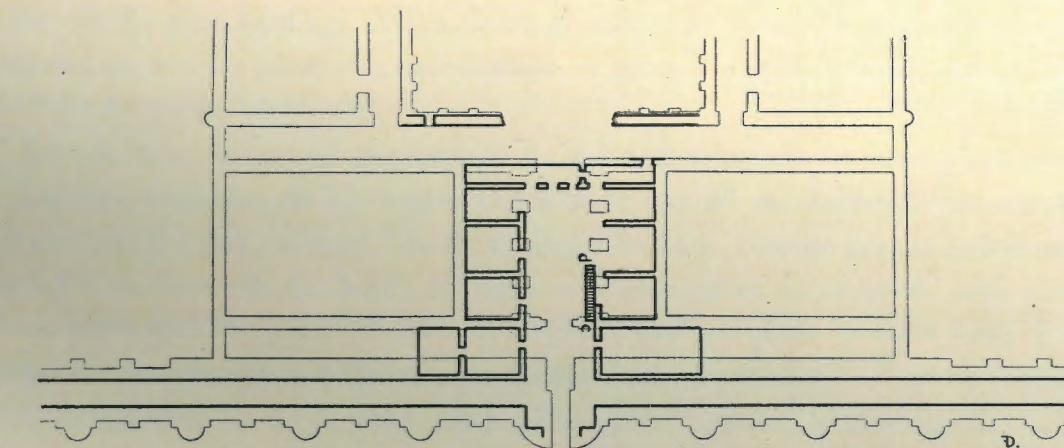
3° Plan du premier étage (trait fin pour rappeler les lignes du plan du rez-de-chaussée sous-jacent).
